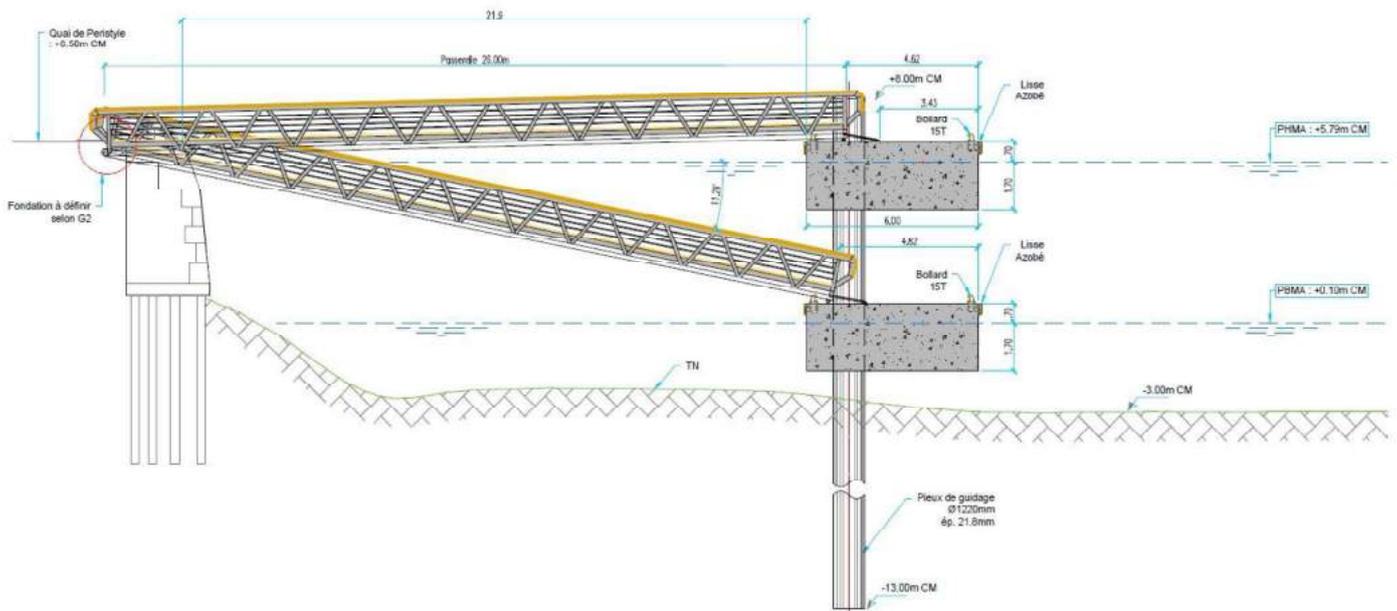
Plan de la passerelle d'accès au ponton (Ingérop, AVP, janvier 2023)
